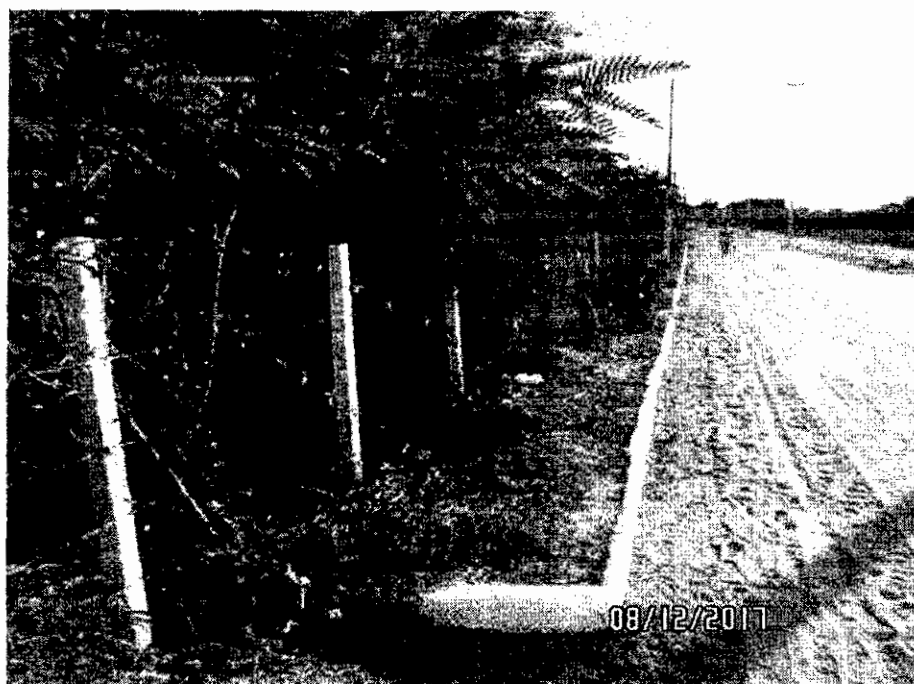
TRECHO SEM PAVIMENTAÇÃO
